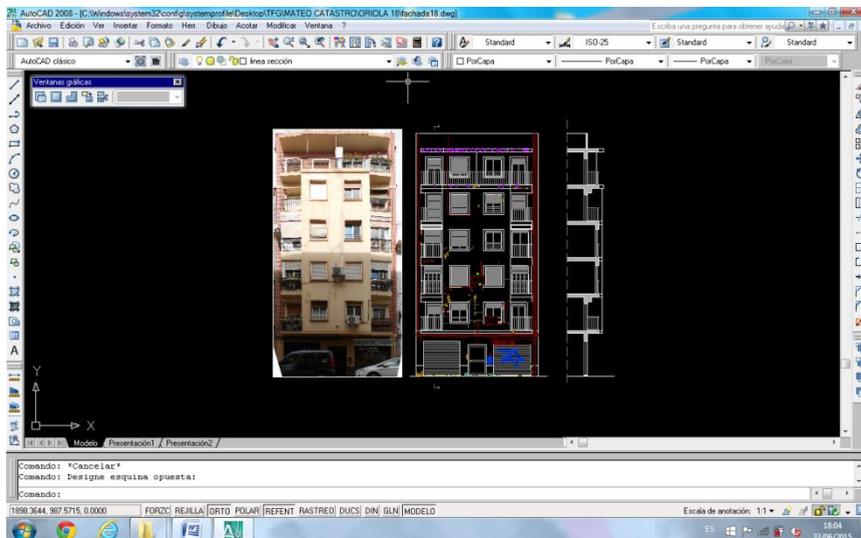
Levantamiento realizado con AutoCAD. Marzo 2015.
